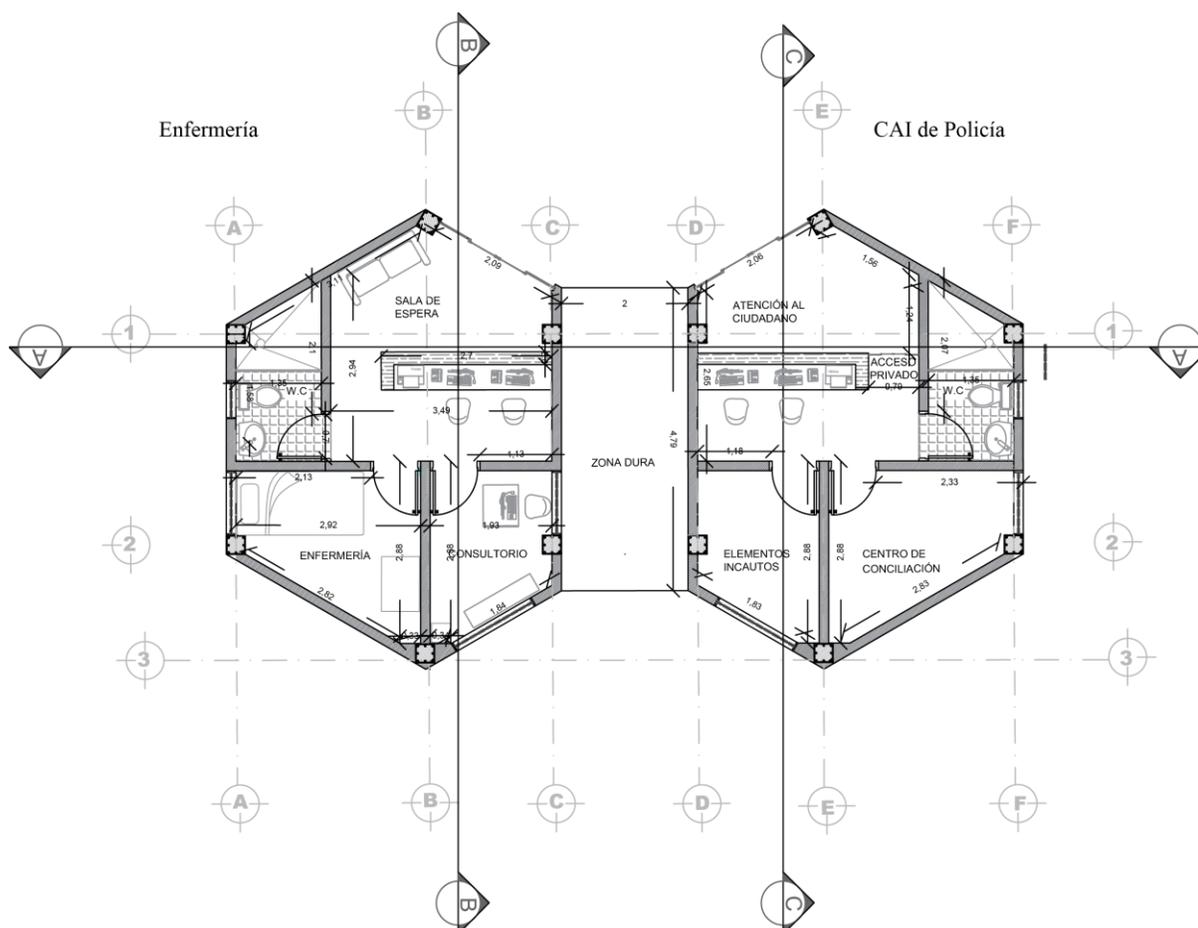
Planta arquitectónica enfermería y cai de policía; Fuente: Elaboración propia
